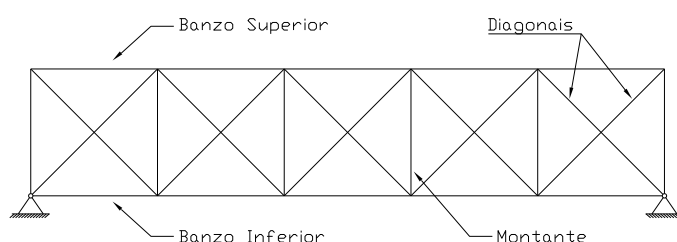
Nomenclatura dos elementos estruturais numa viga treliçada
